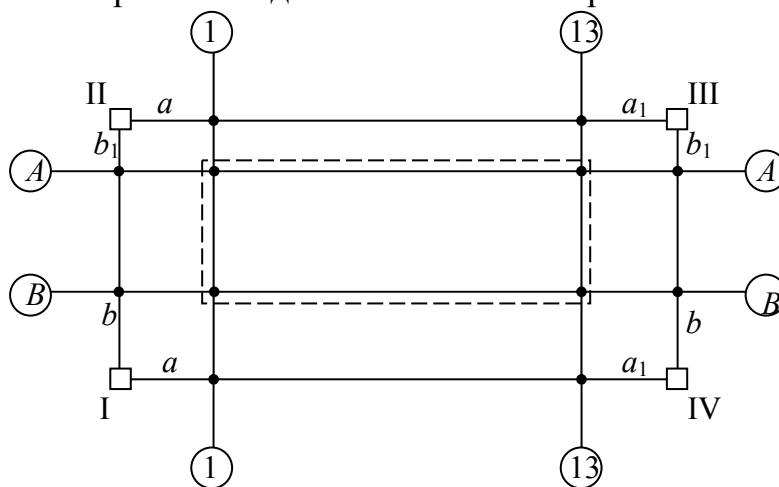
Схема перенесения осей здания от строительной сетки способом створных засечек
